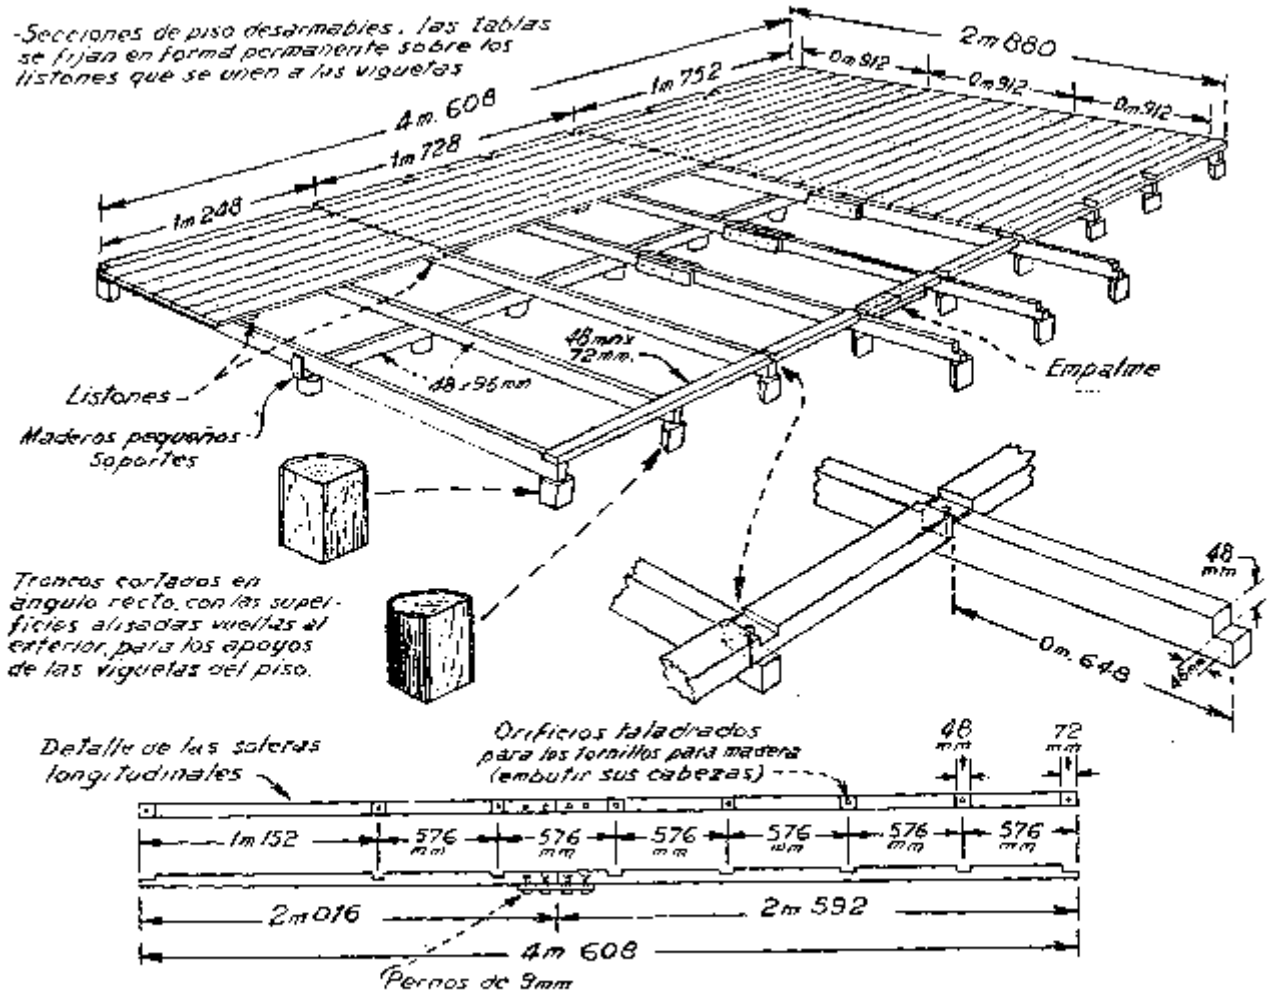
Forma en que se prepara el piso para ser desarmado fácilmente en distintas secciones que, armadas y fijadas con pernos, constituyen un firme pavimento. Las viguetas se empalman sobre apoyos, a los que se fijan con pernos, de modo que al tornarlo sobre el que se asienta el piso no necesita recibir más preparación que el nivelado.
